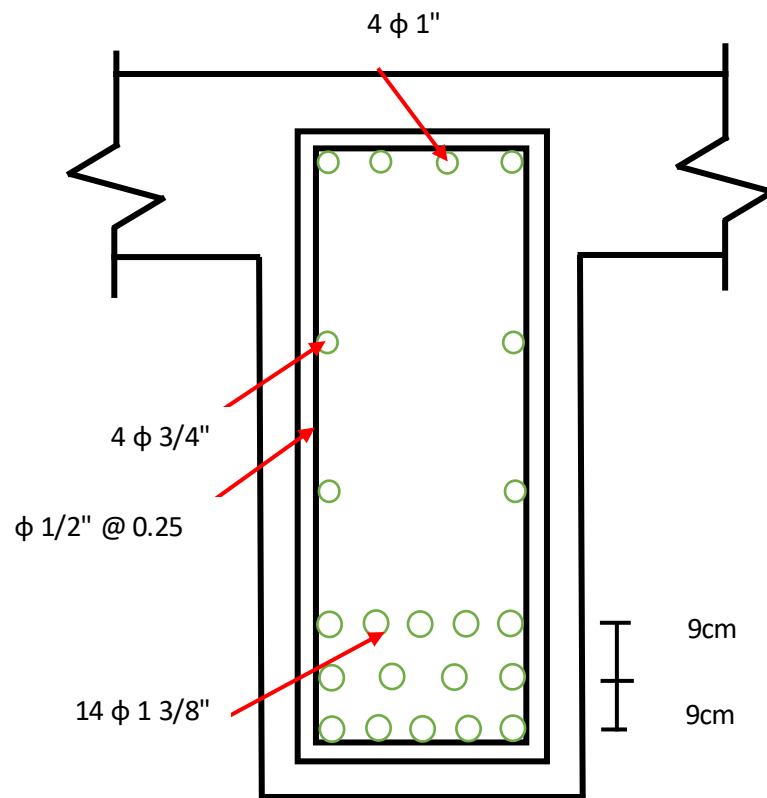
SECCION DE LA VIGA-FUENTE: ELABORACION PROPIA
